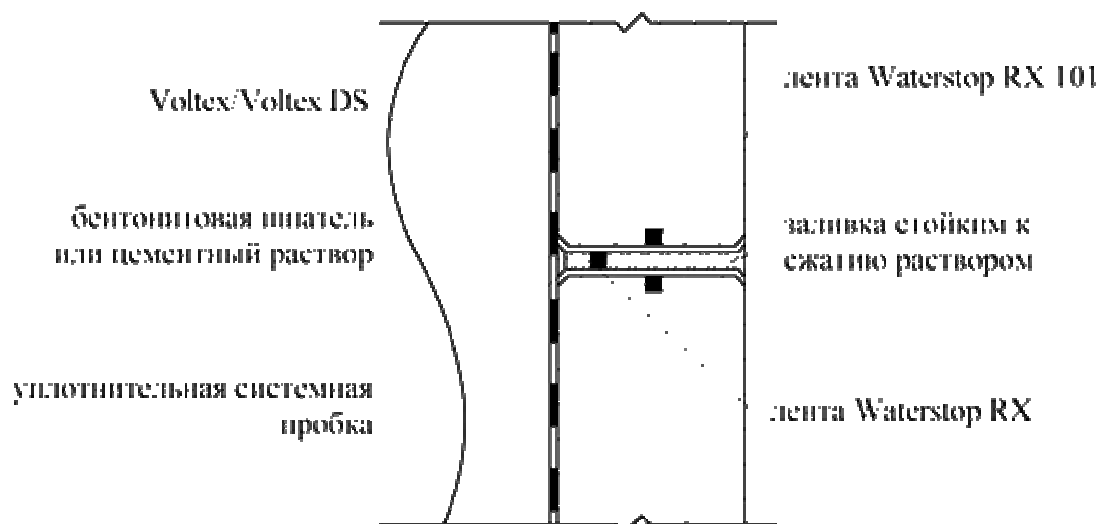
Устройство уплотняющей гидроизоляции в местах отверстий от стяжных болтов опалубки
